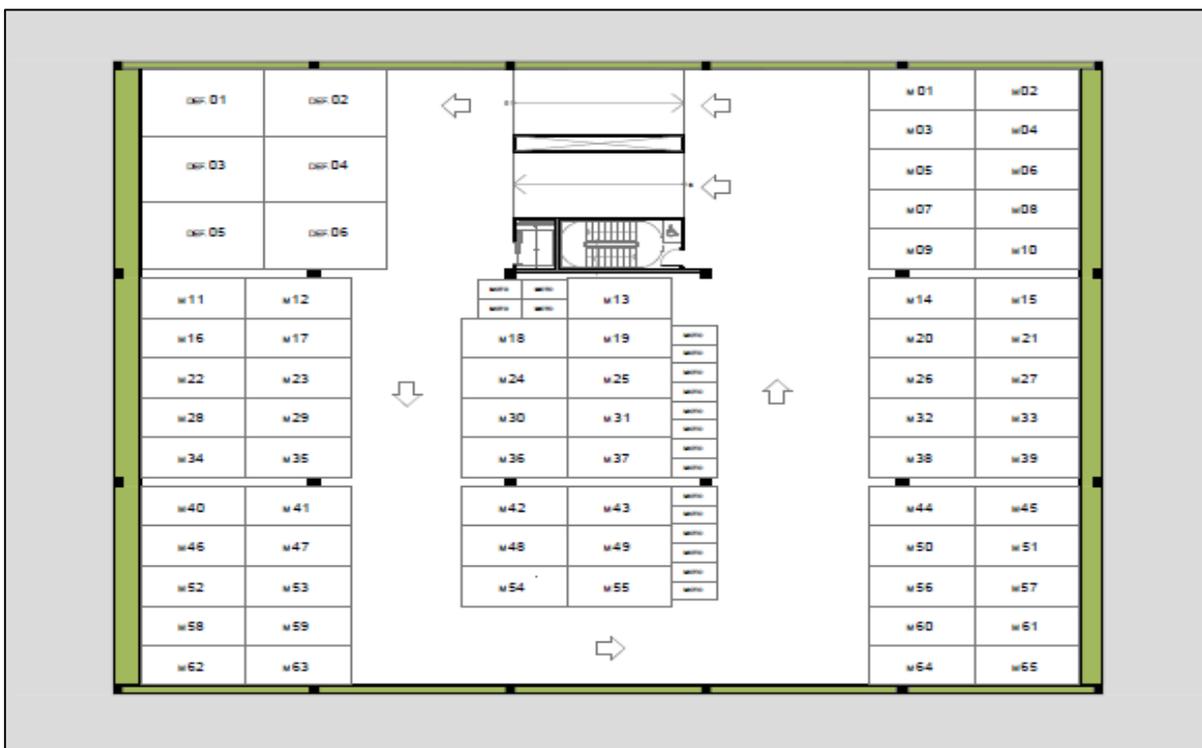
Planta do 1º pavimento, contendo 65 vagas e 6 destinadas a deficientes.
